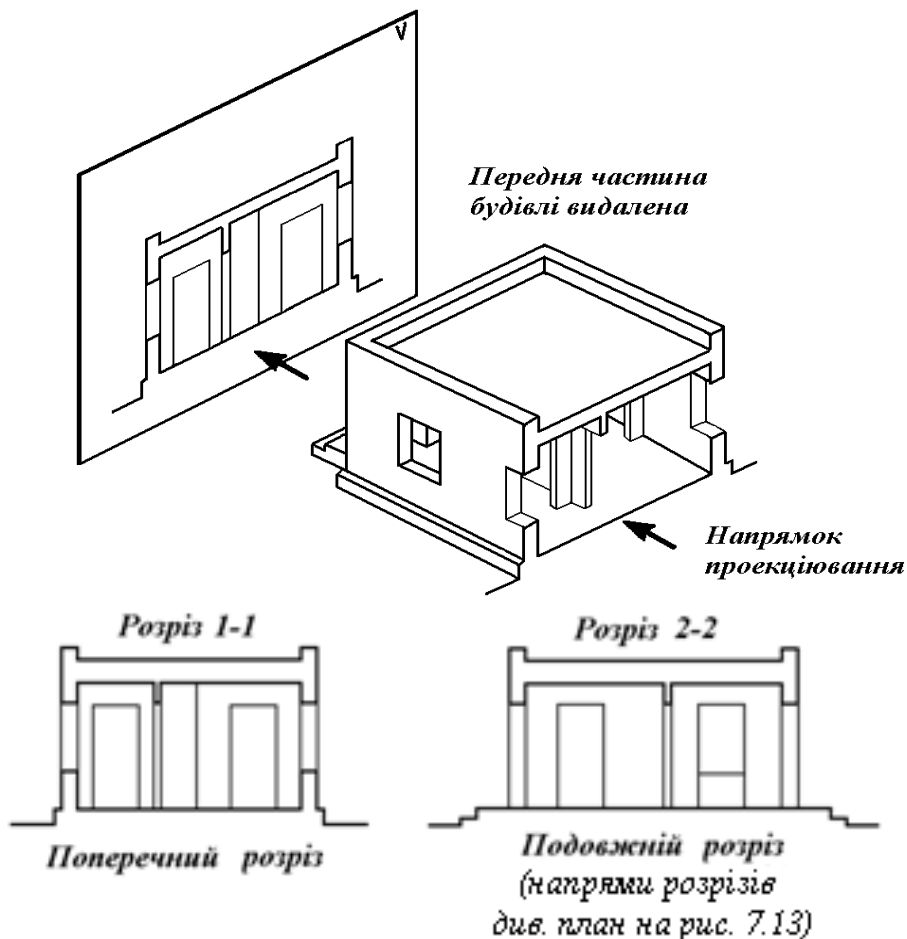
Створення подовжнього і поперечного розрізів будівлі
